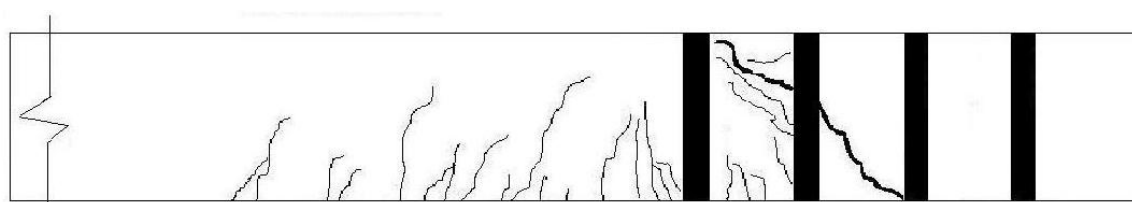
Panorama de fissuração da Viga V25.
